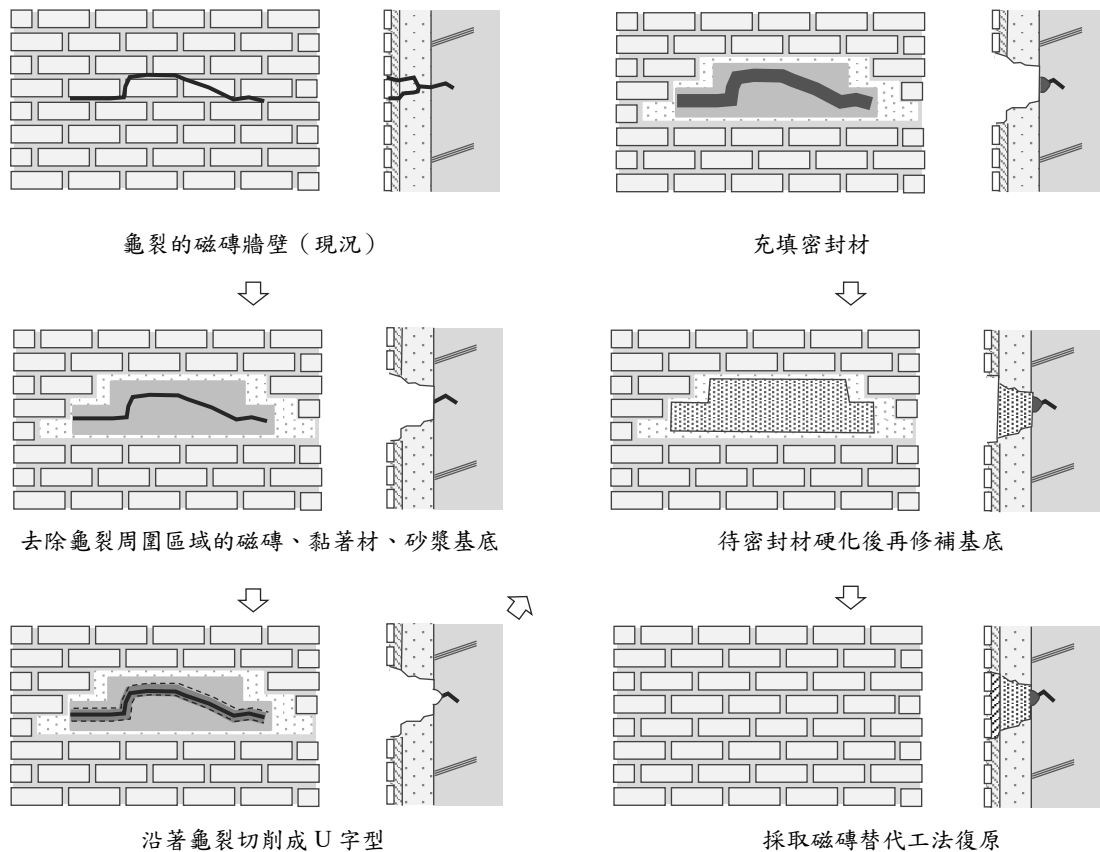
U 字型切削密封材充填工法概要 (從結構混凝土開始龜裂)
